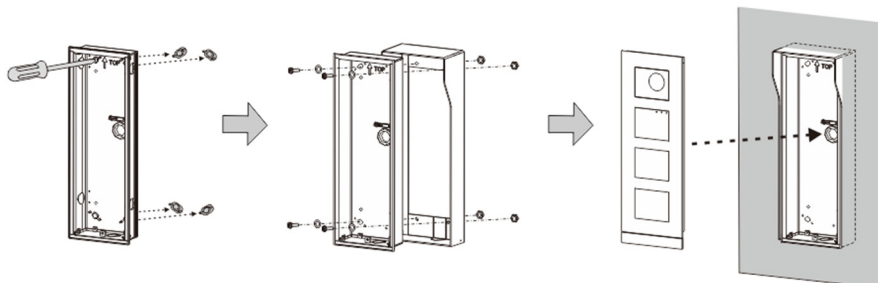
Montaggio a incasso con copertura di protezione contro la pioggia
